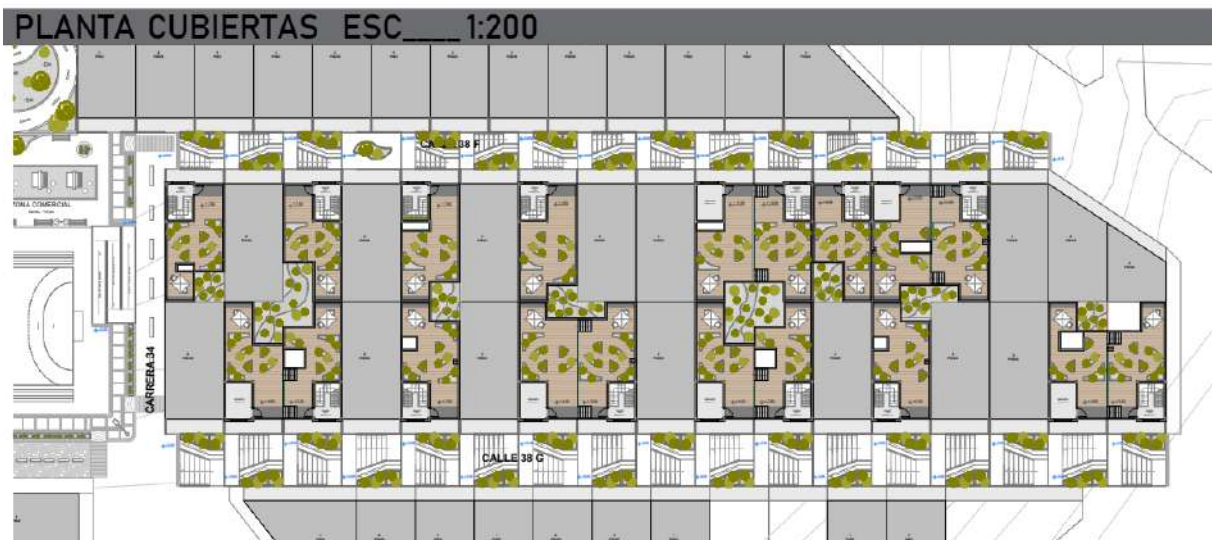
Planta de Cubiertas. Fuente: Autor 2019
